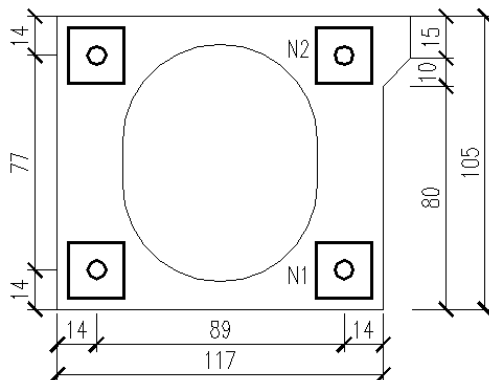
钢束边板-支 (尺寸单位:cm)
